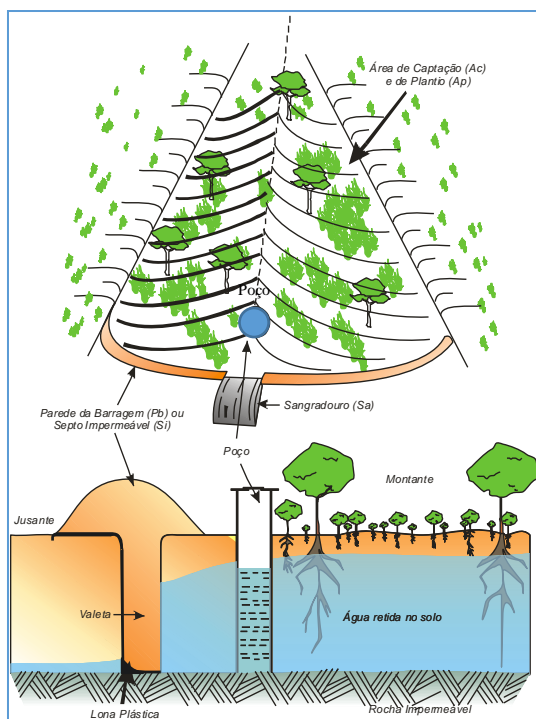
Vista aérea de uma barragem subterrânea, com detalhe da localização do poço e recorte longitudinal da parede. Fonte: Adaptado pelo IRPAA
